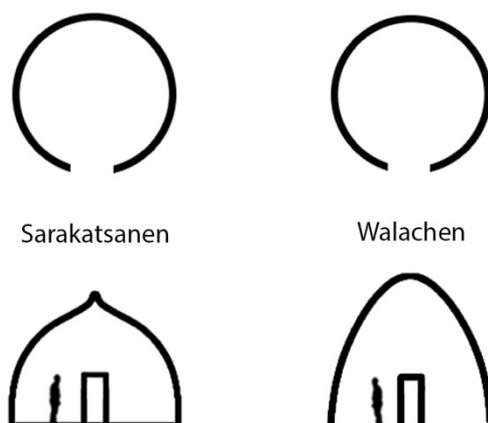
d: Sarakatsanische und walachische Hütte mit kreisförmigem Grundriss
